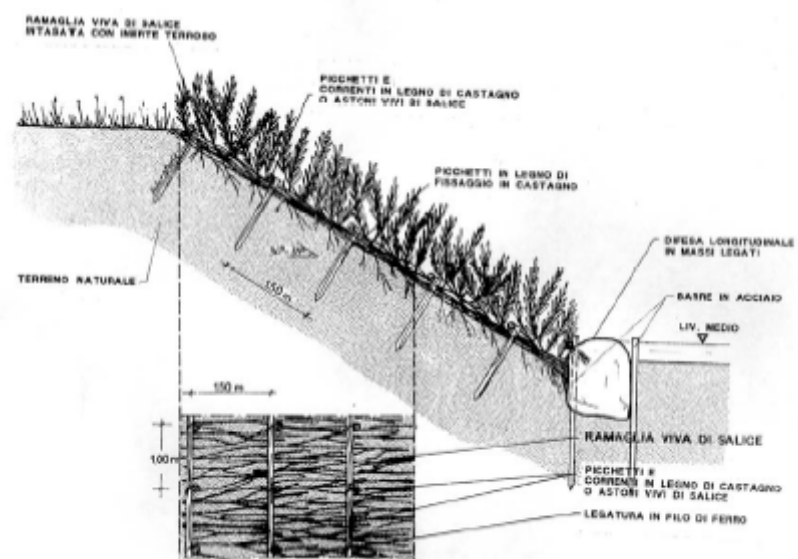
Sezione tipo di copertura diffusa con ramaglia viva
